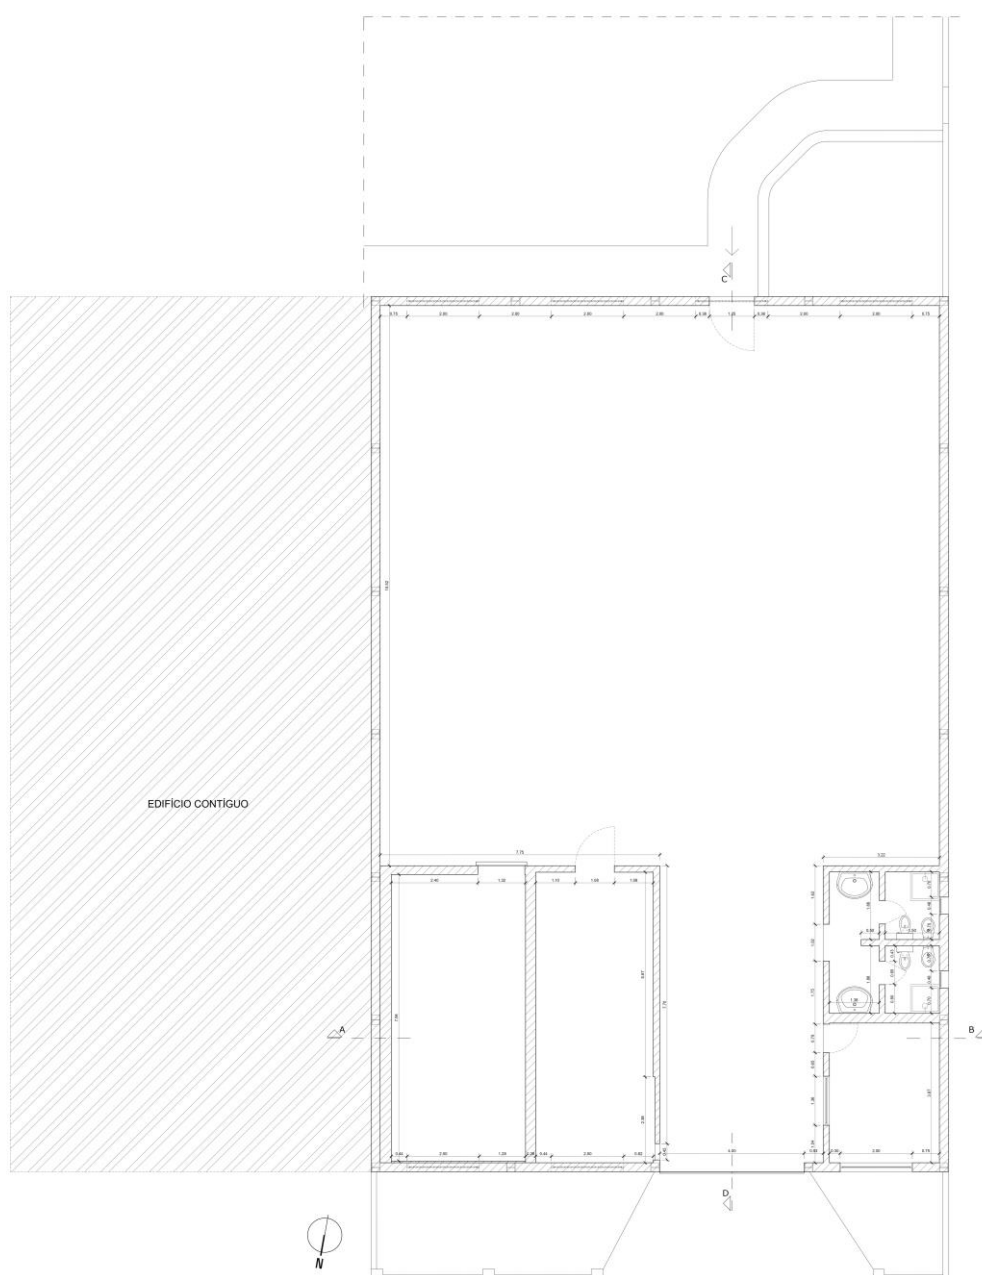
Desenho Técnico - Planta Existente. Fonte: (Autor)
